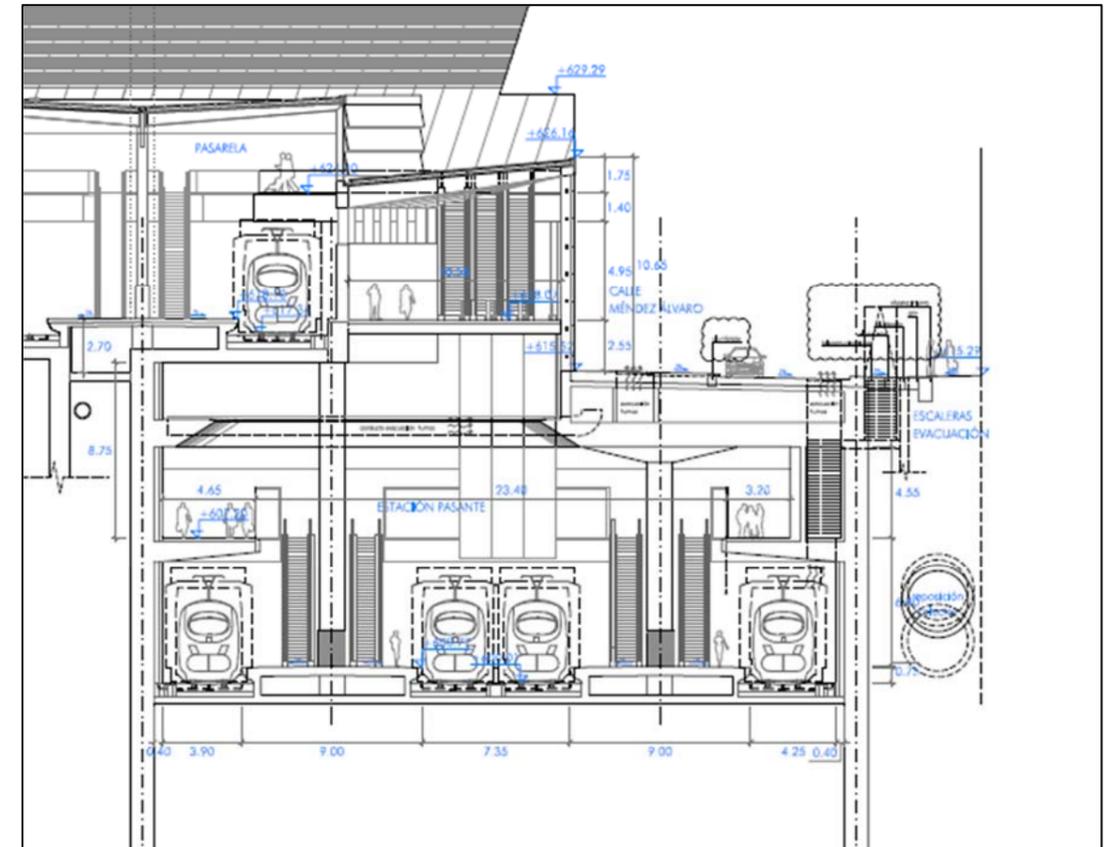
Estación Pasante. Sección por zona central de losa nivel 607
